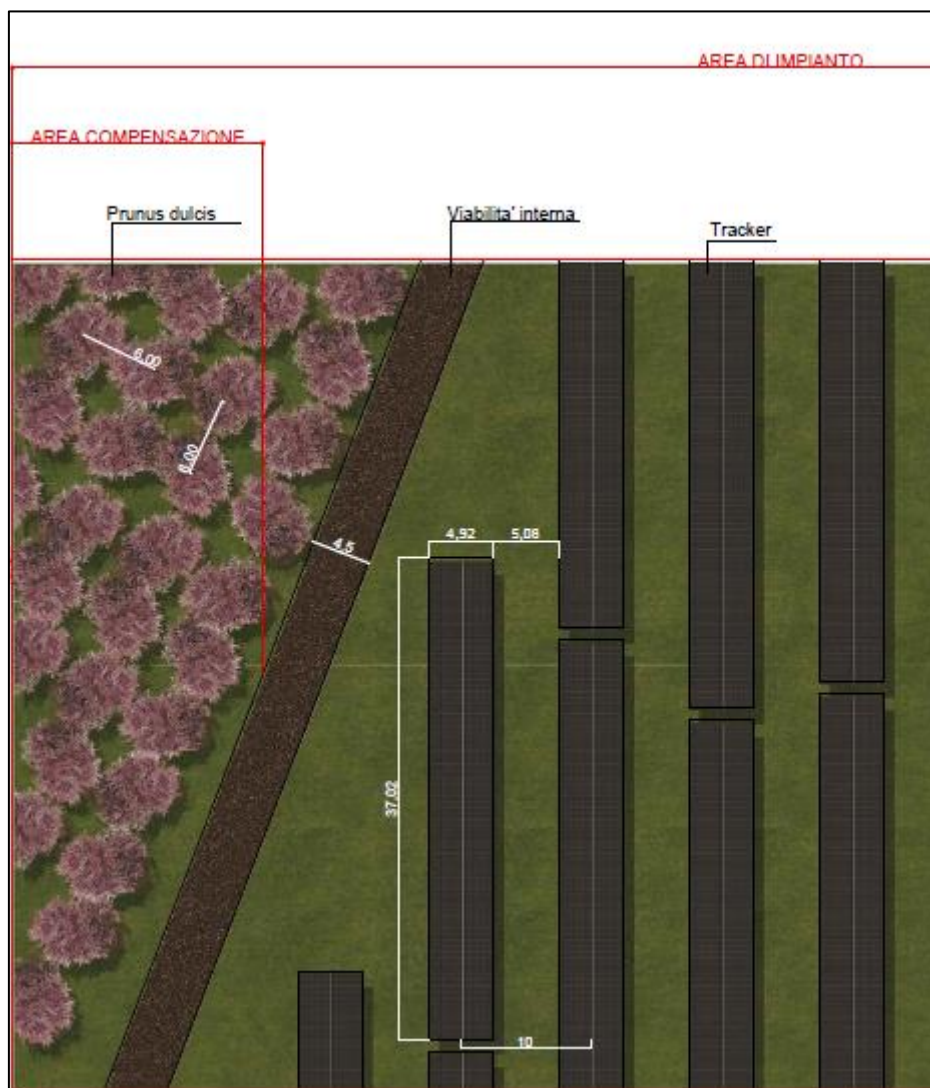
planimetria dell'area di impianto e di una delle aree di compensazione destinate all'impianto di mandorli.
